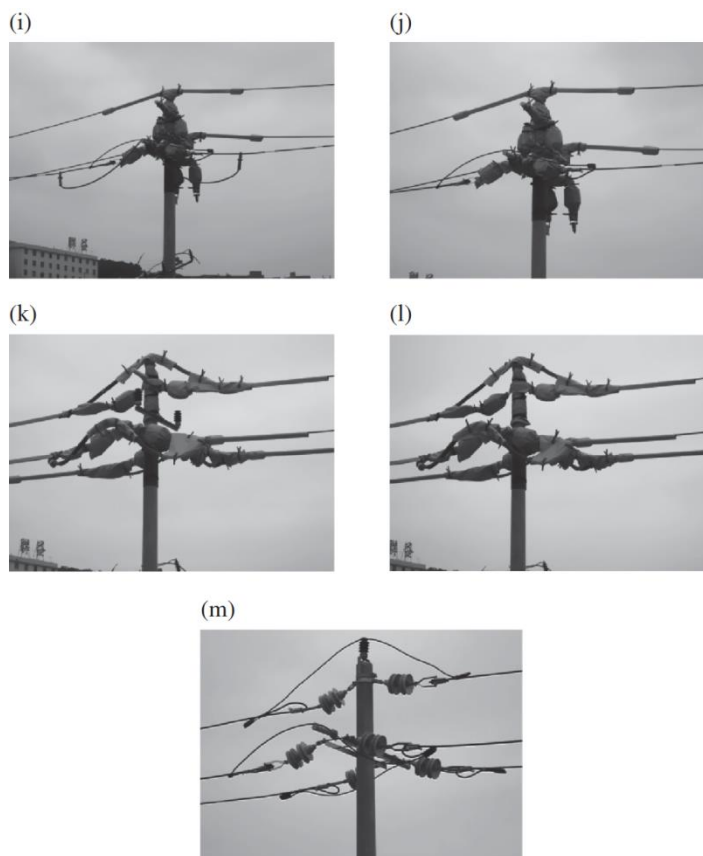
(Продолжение) Замена подвесных опор на натяжные (III). (i) установка перемычек; (j) снятие байпаса маневровой проволоки; (k) установка изолирующих покрытий после снятия; (l) снятие траверс подвесных опор; (m) натяжная опора после демонтажа.
